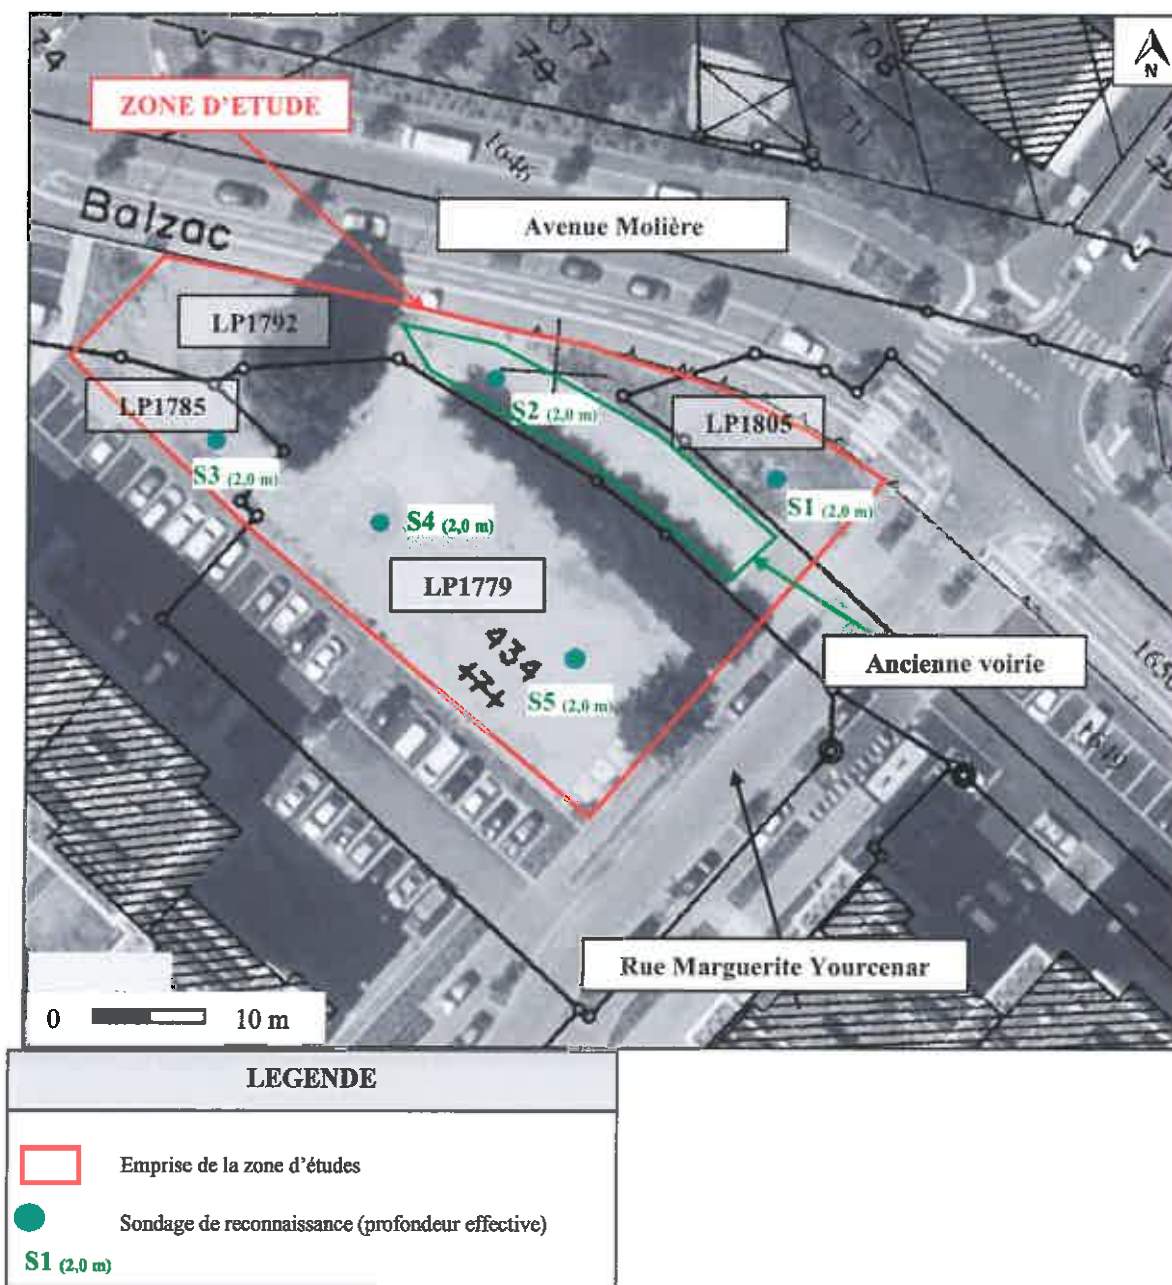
Plan de localisation des sondages carottés au droit de la zone d'étude
